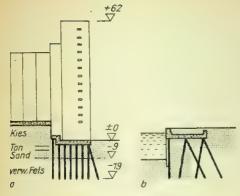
Pfahlgründung: a Silogebäude. b Kaimauer
